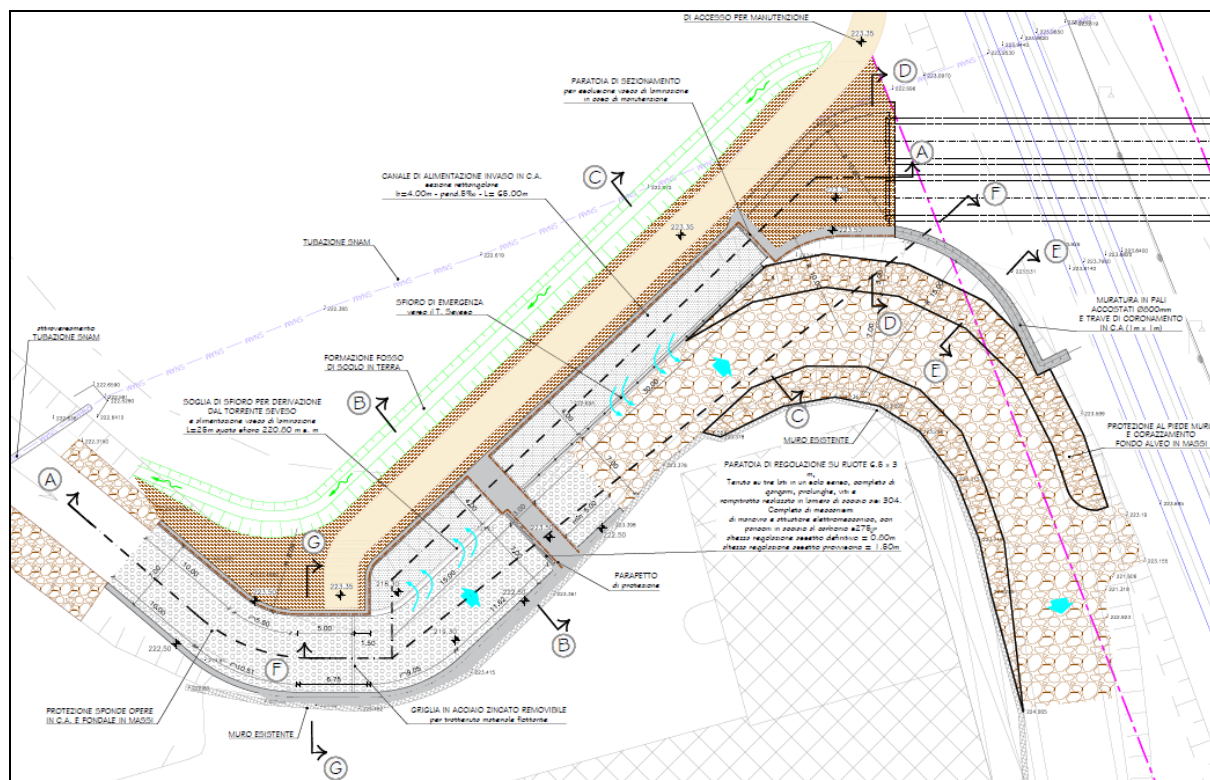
Stralcio opera di presa dal T. Seveso - pianta.
